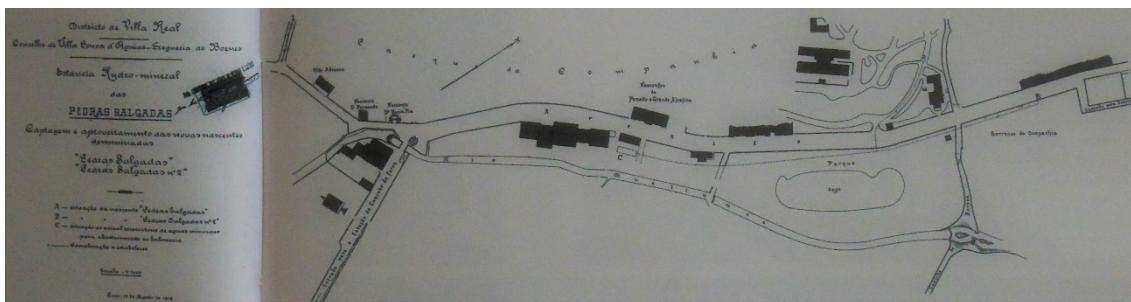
Planta do parque de Pedras Salgadas em 1912.
